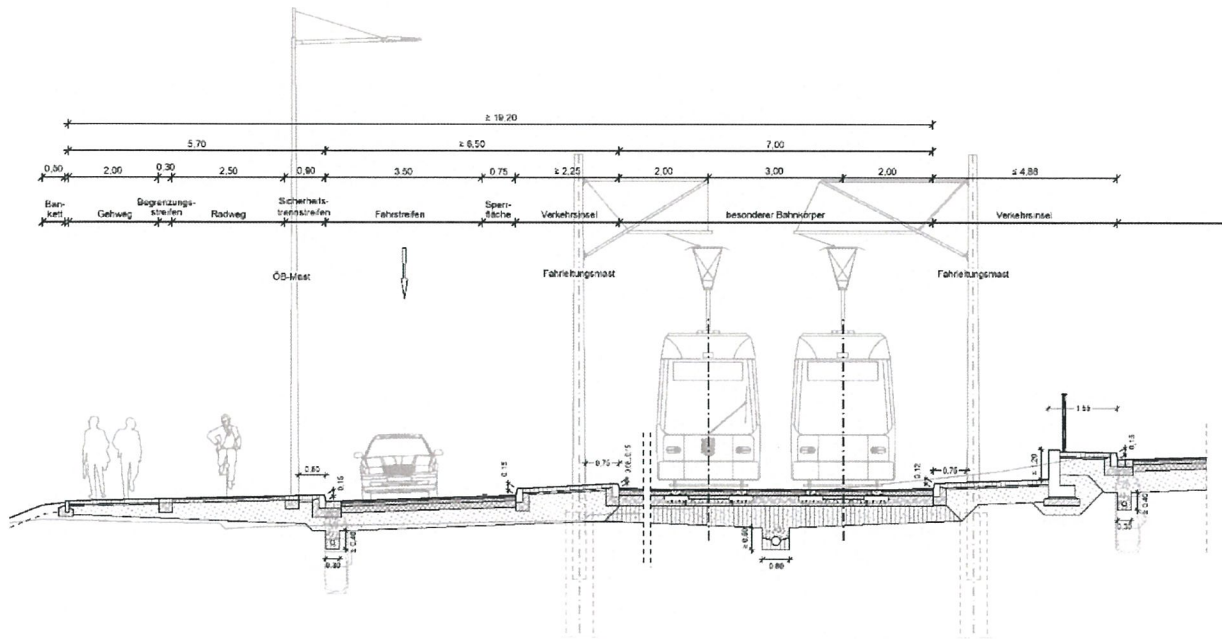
Querschnitt Oederaner Straße bis Fabrikstraße (Gleisbereich und stadtauswärtige Fahrbahn)
